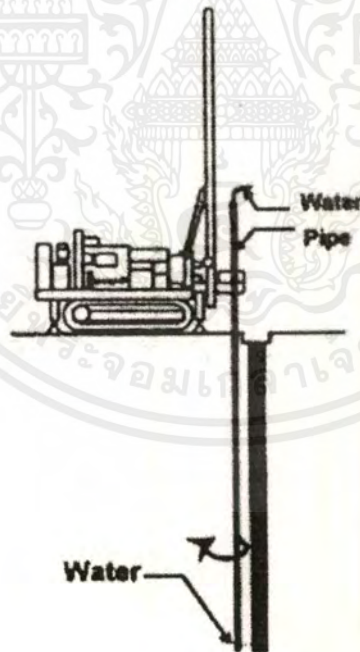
แสดงการขุดเพื่อตรวจสอบขนาดของ Jet Grouting Pile (โครงการปากพ่อง)
